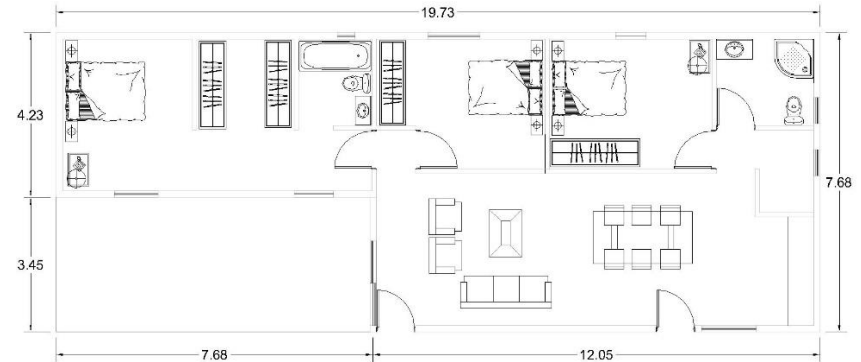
Planta de distribución arquitectónica 125.03 m² + 26.49 m² de porche, con dimensiones generales de 19.73 m. de longitud por 7.68 m de ancho y un total de 151.52 m² de construcción (HOME 3, 2016).
